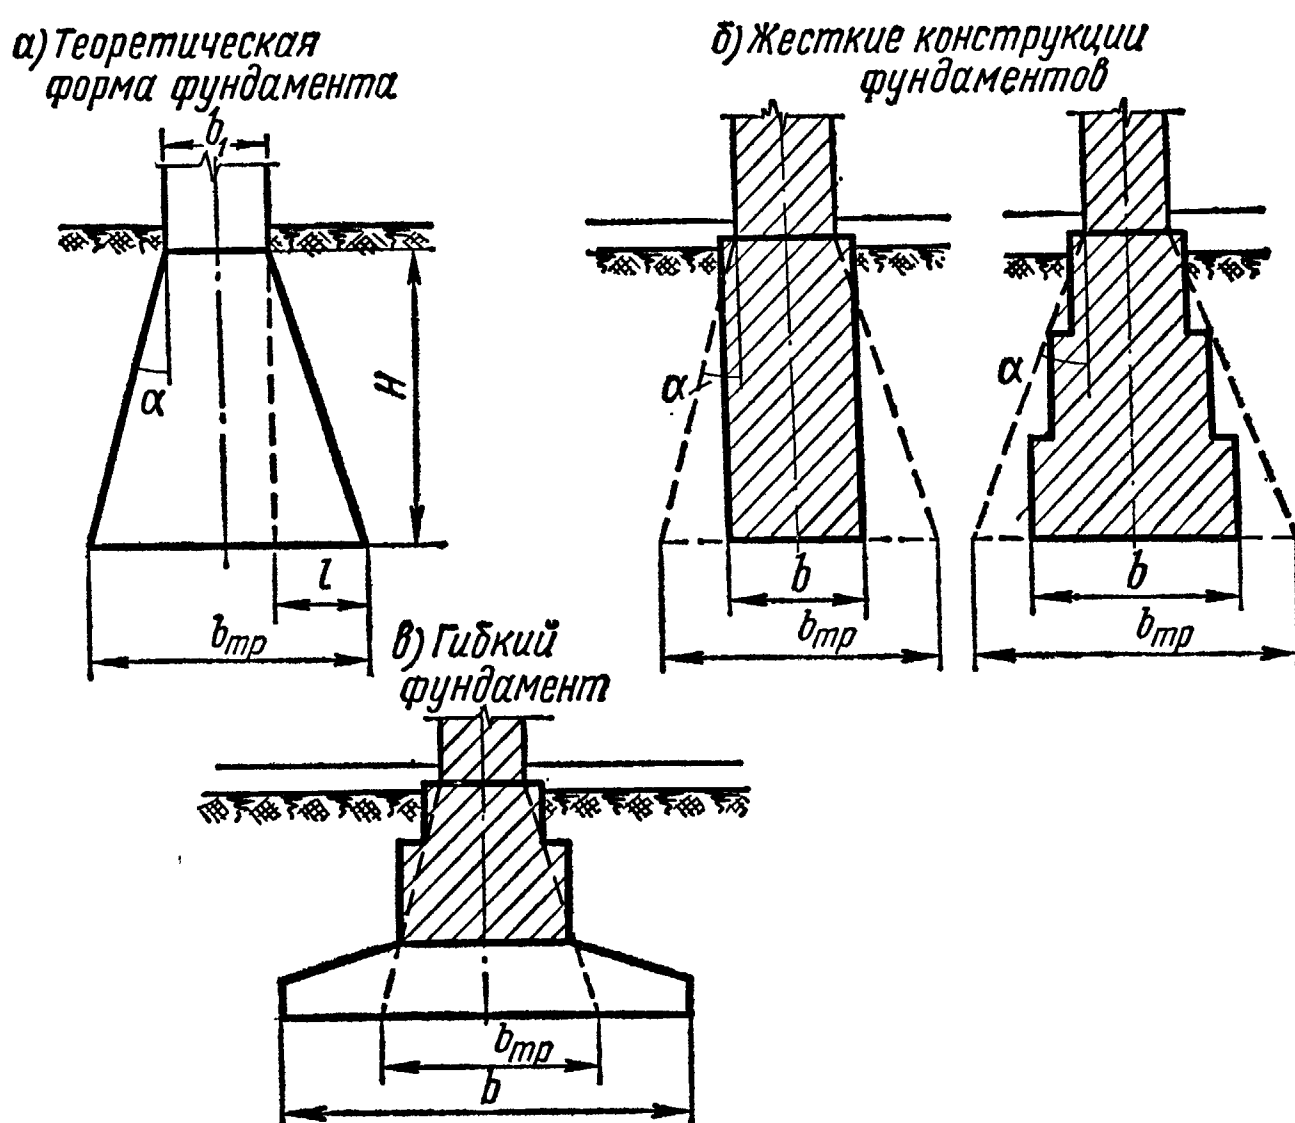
Схемы, дающие понятие о жесткости фундаментов
